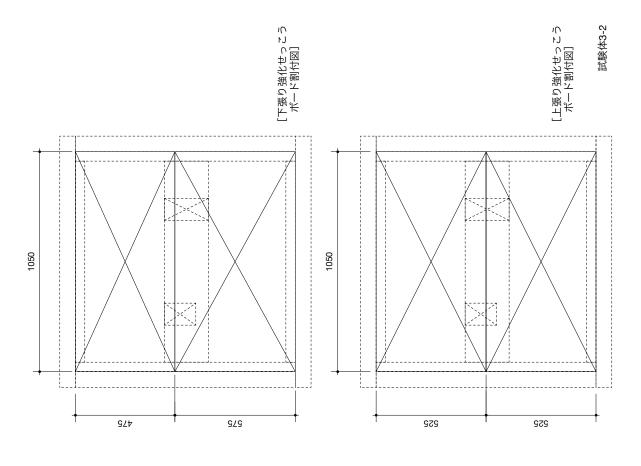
試験体 3-2 壁-床取合い部 試験体図
